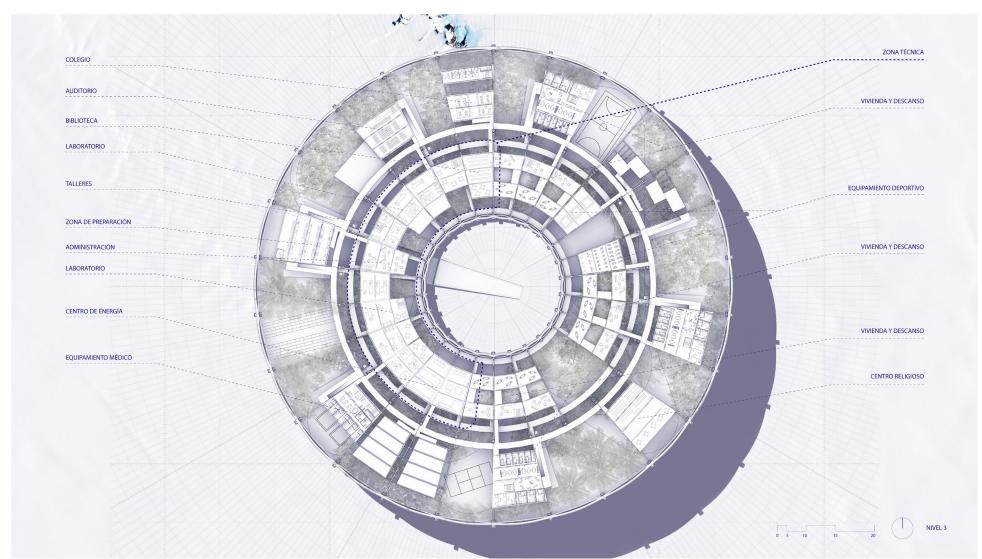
Planta nivel 3, Elaboración propia, 2021.
